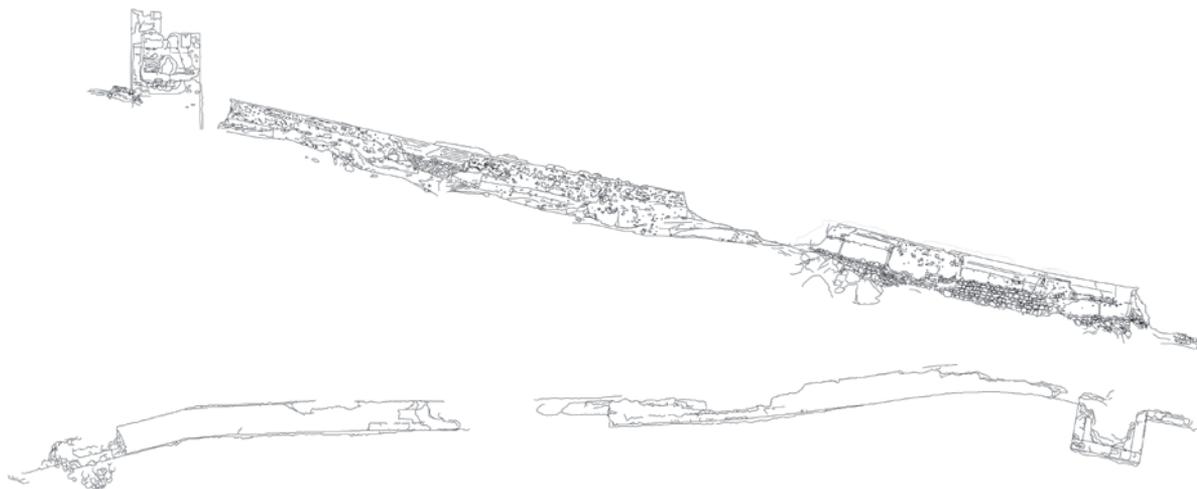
Detalle de construcción del lienzo de la muralla.
